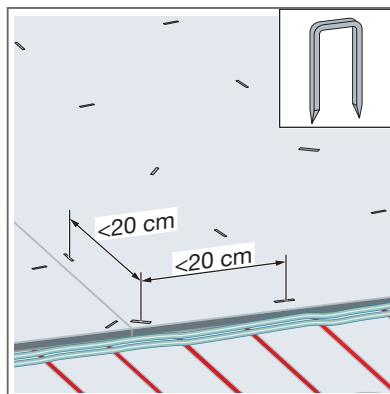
Gipsfaserausbauplatten mit Spreizklammern befestigen
